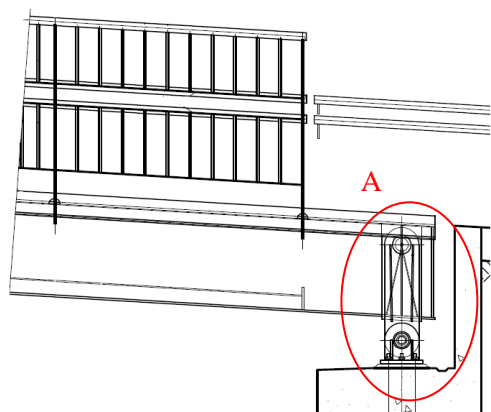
Apoio na zona dos encontros, na concepção com viga caixão [24].
